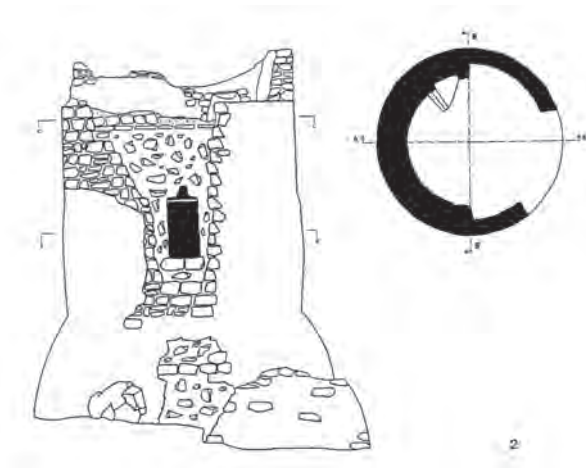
Alzado y planta de la torre según J. Pelluch (1993).
